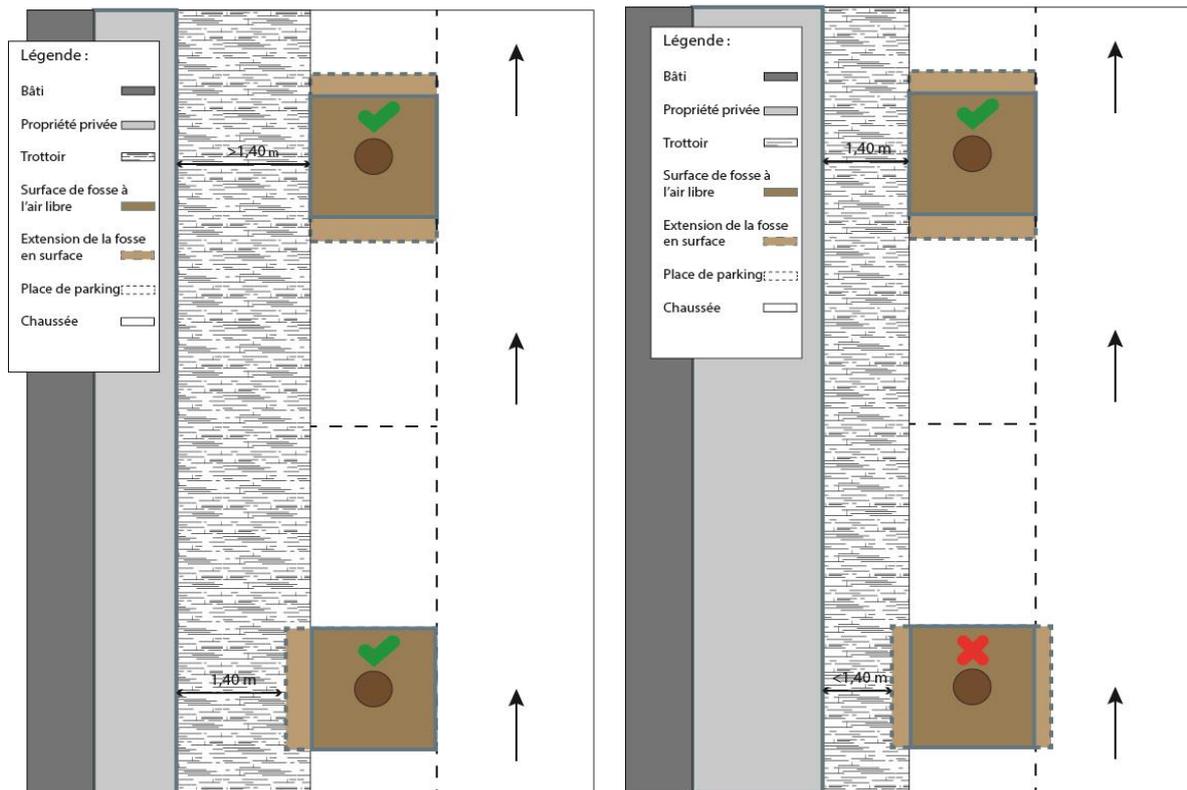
Schémas de configuration d'une fosse selon la largeur du trottoir (Plantation sur chaussée et trottoir de grande largeur à gauche et plantation sur chaussée uniquement avec trottoir à largeur minimale). (M. Cornut,2021)
